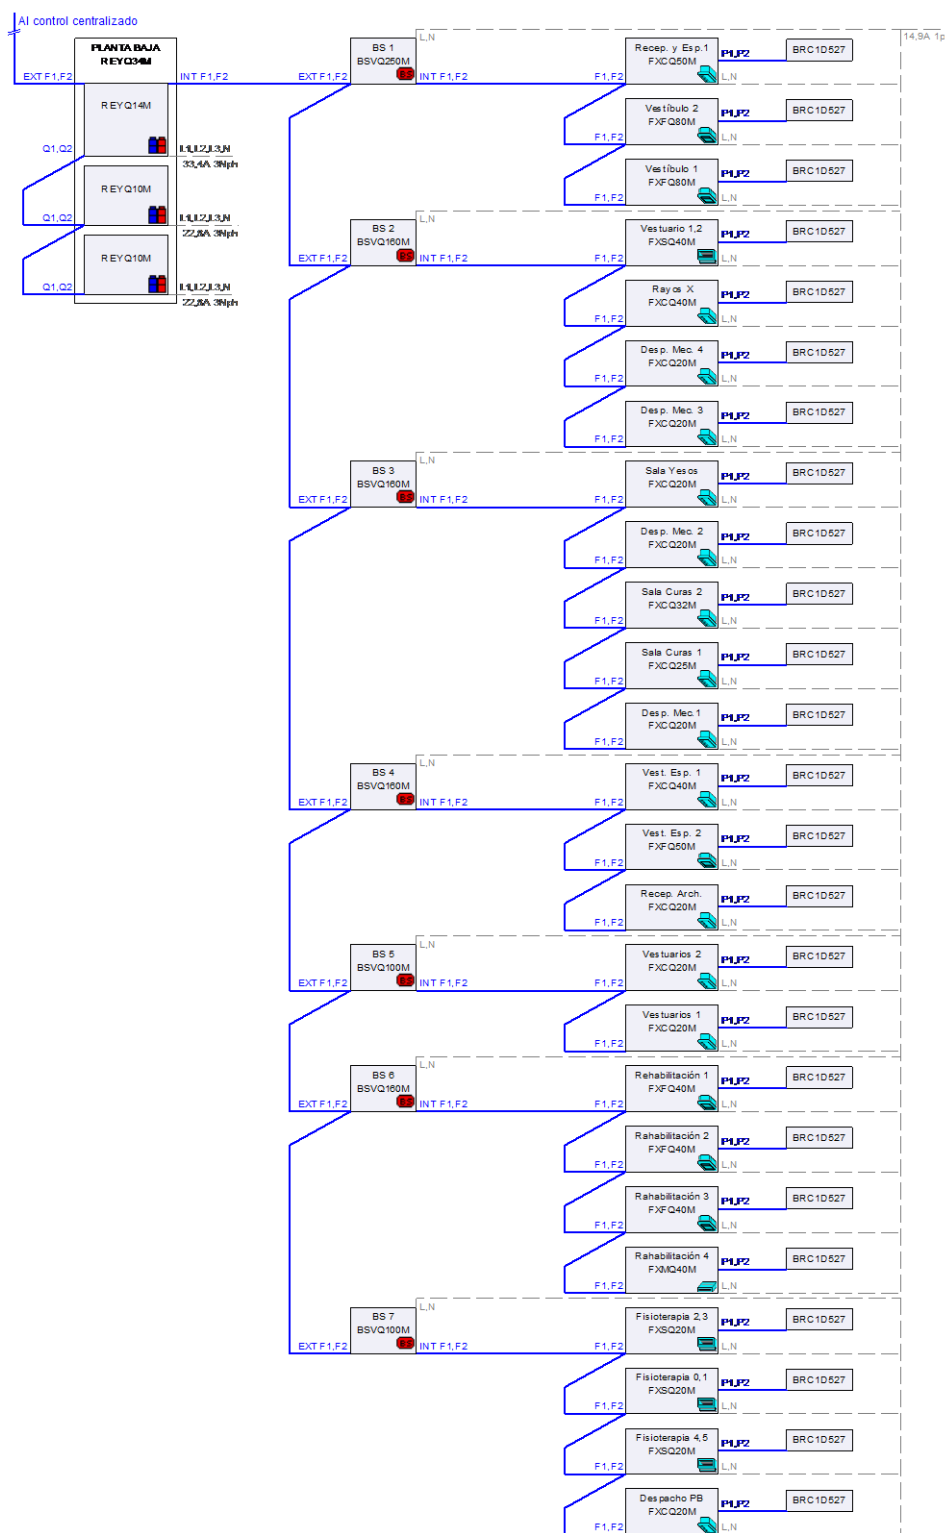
Esquema conexión eléctrica VRV. PLANTA BAJA
